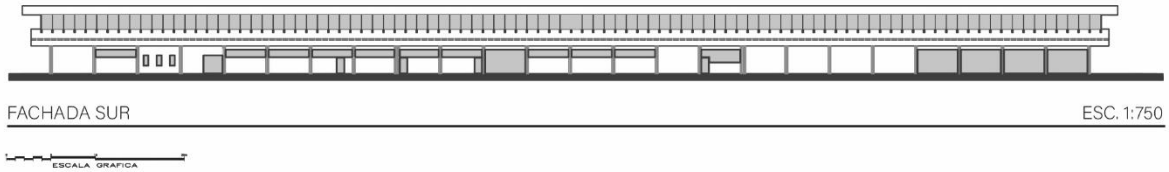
Fachada de la Comandancia de la Zona Norte (CZN).
